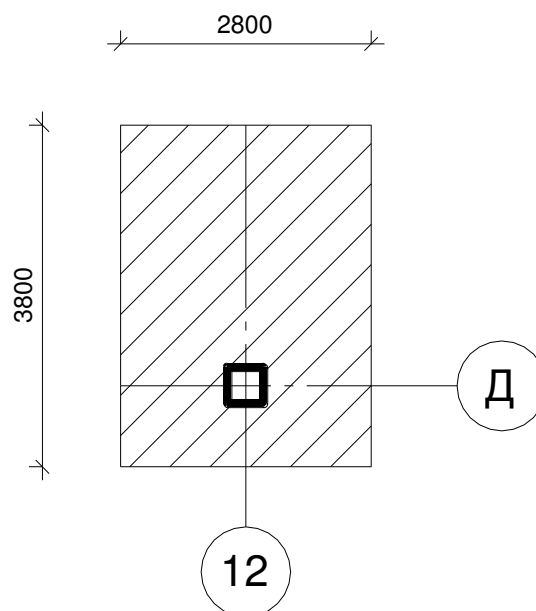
Схема для сбора нагрузок на колонну
